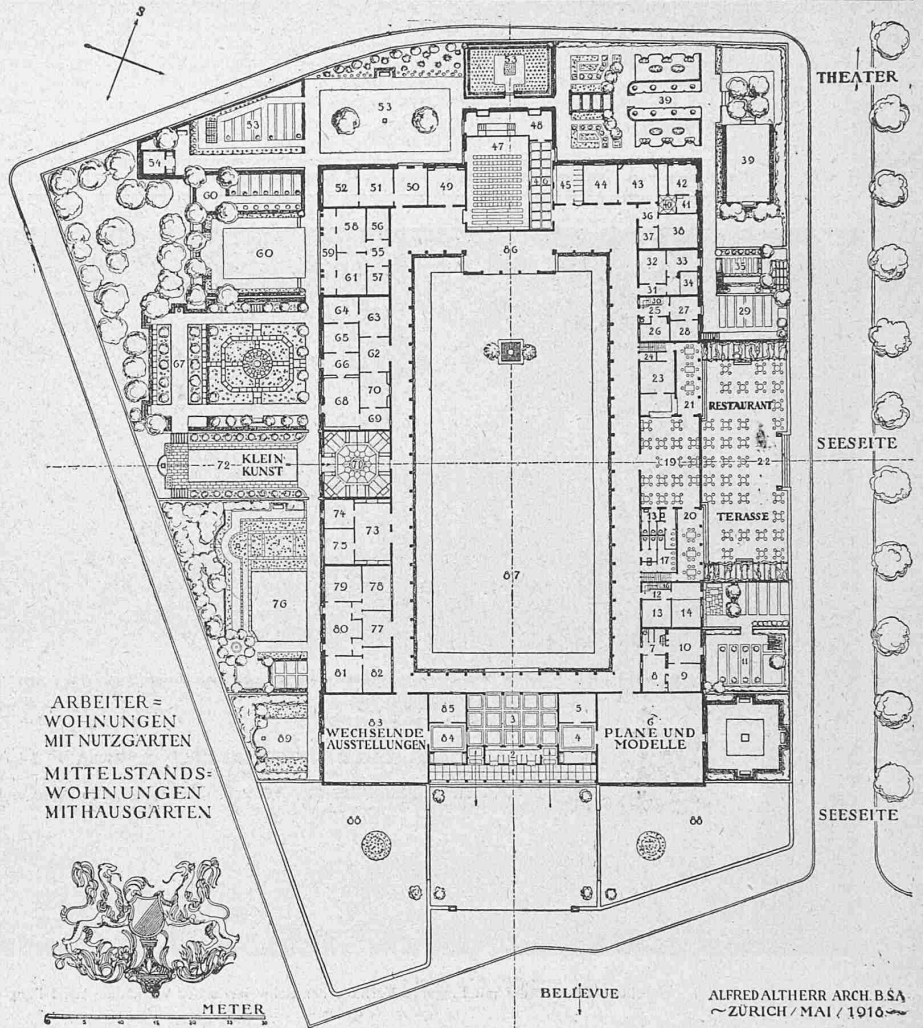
Lageplan mit Grundriss des Ausstellungs-Gebäudes. — Massstab etwa 1:900.
